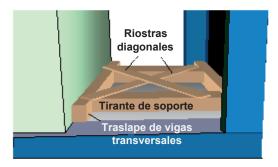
Medio de soporte con el traslape de las vigas transversales y riostras diagonales
